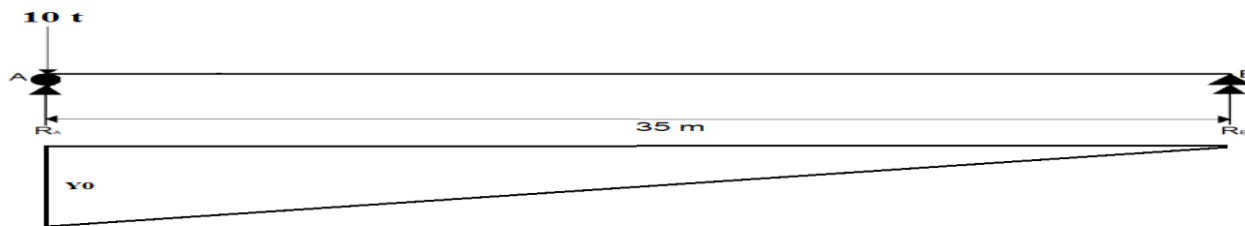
Disposition du convoi Br (pour la section $x=0.0L$)
